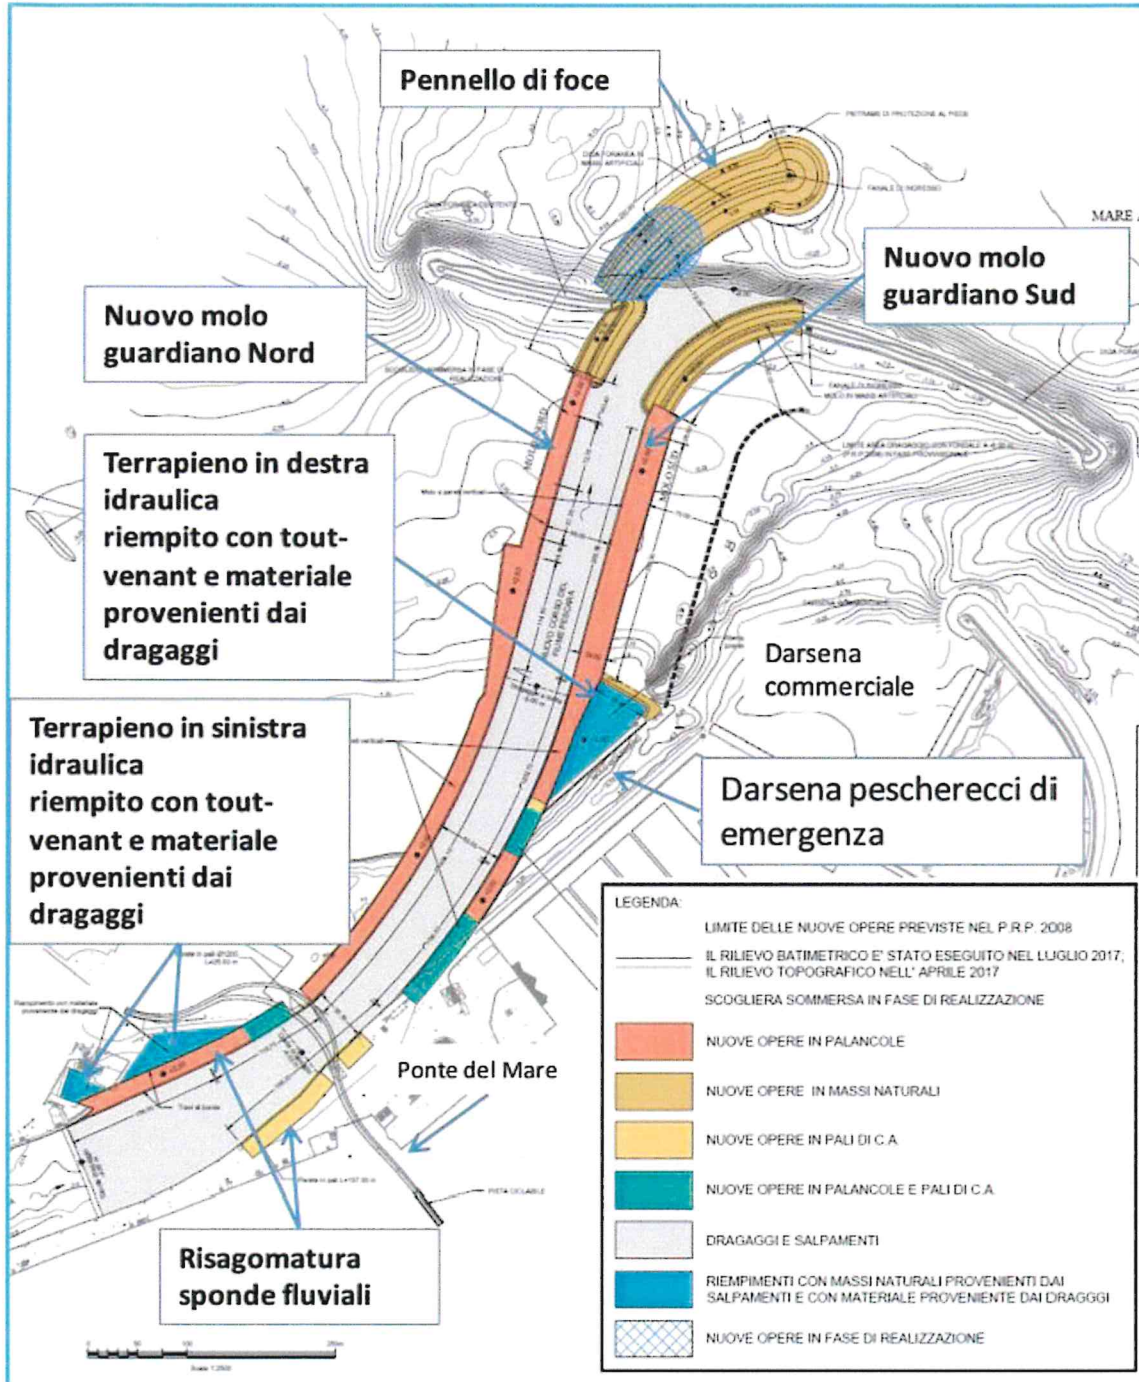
PLANIMETRIA DELLE OPERE IN PROGETTO
